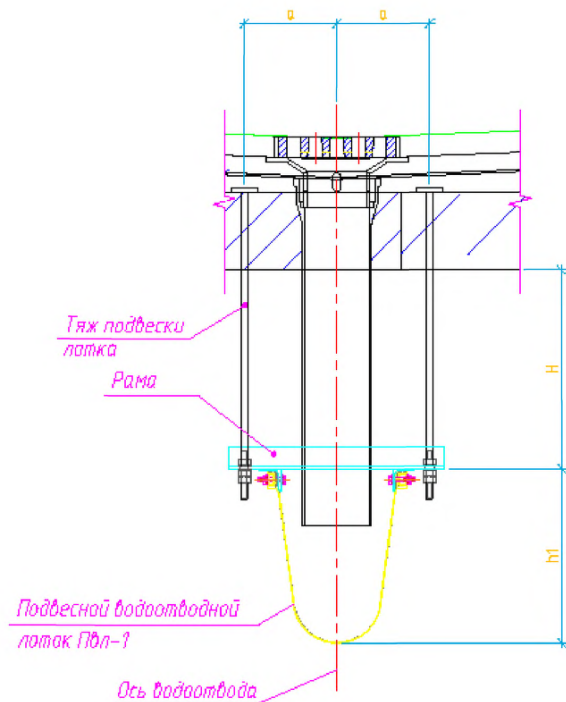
Конструкция крепления открытого подвесного водоотводного лотка из композитных или полимерных материалов:
